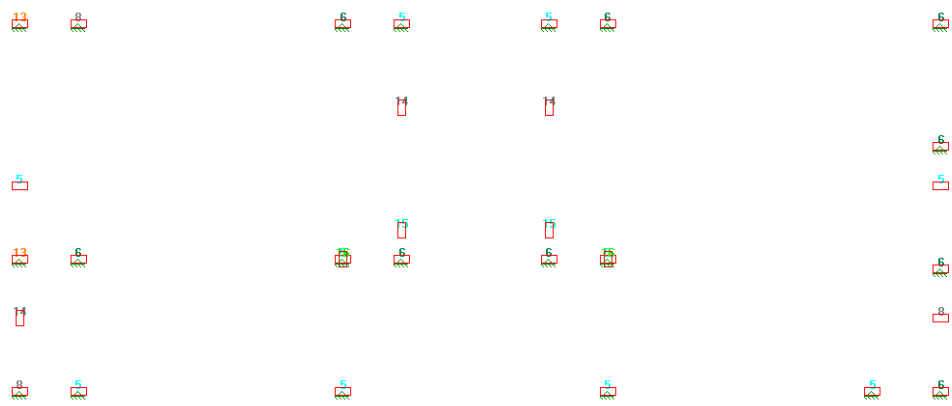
Orientação das seções dos pilares em planta e suas propriedades
